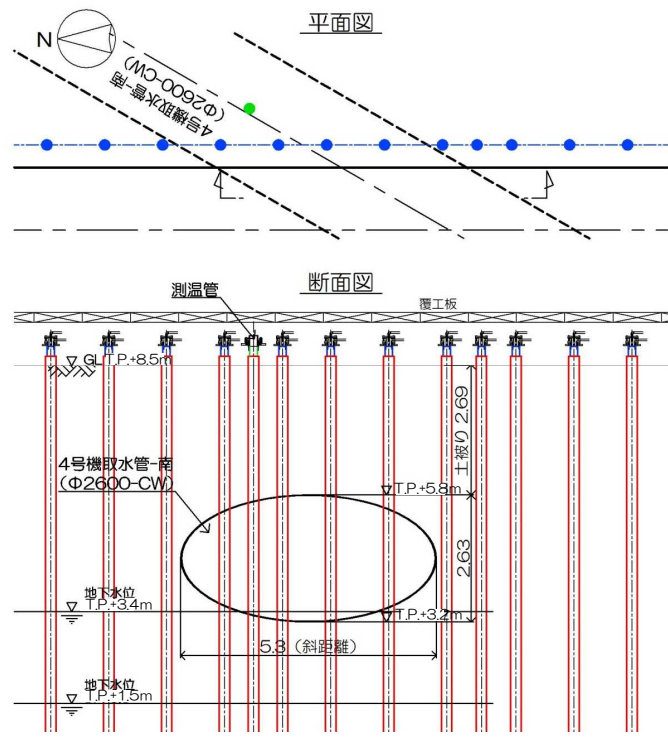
【10-4】4号機海水配管（SW）埋設ダクト 施工方法（複列施工）
